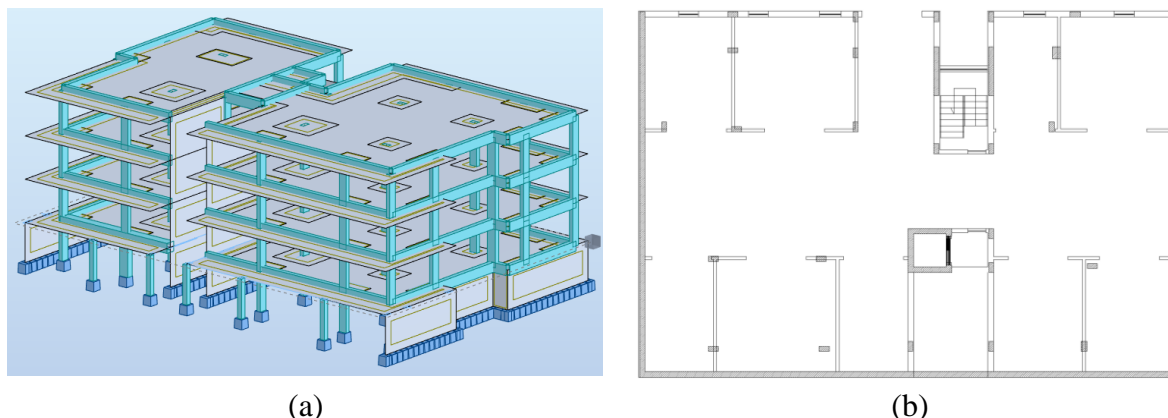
(a) Modelo estrutural (*Robot Structural Analysis 2019*). (b) Planta estrutural da cave (*AutoCAD 2018*).
